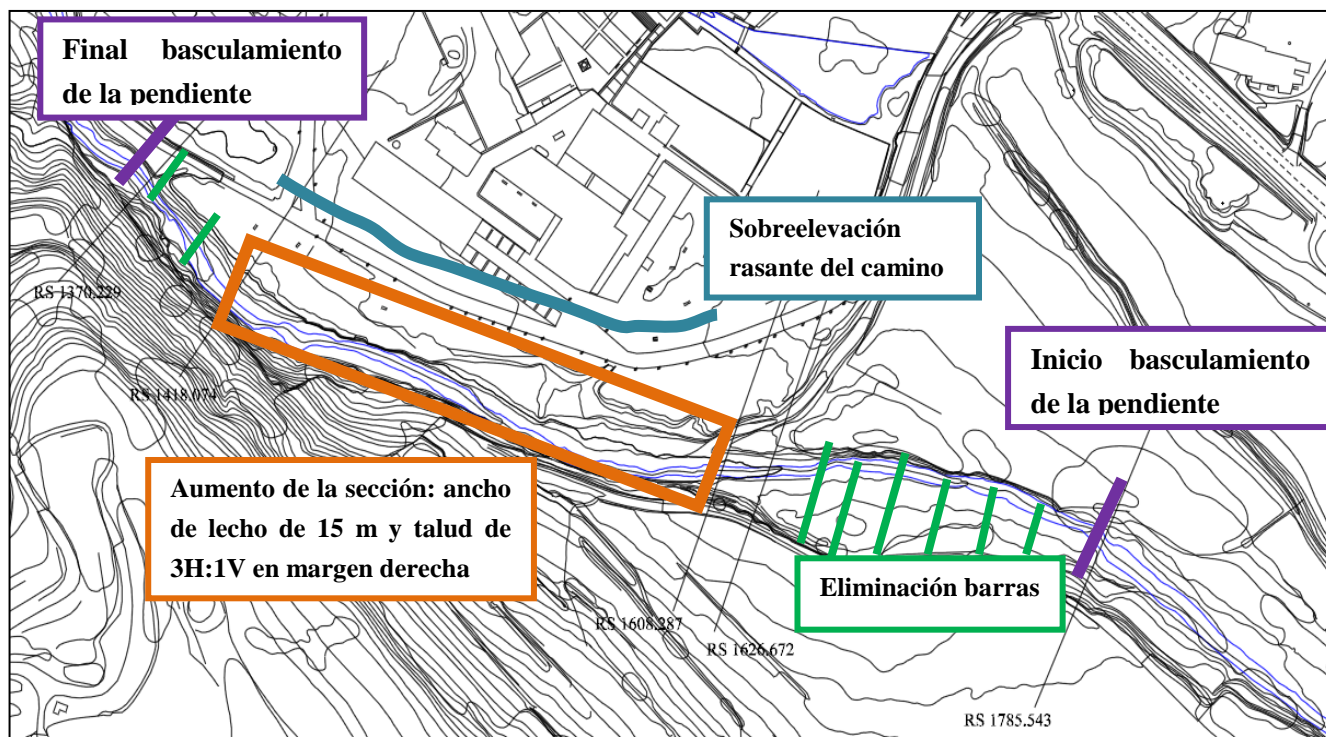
Esquema en planta de las actuaciones para la alternativa 2
